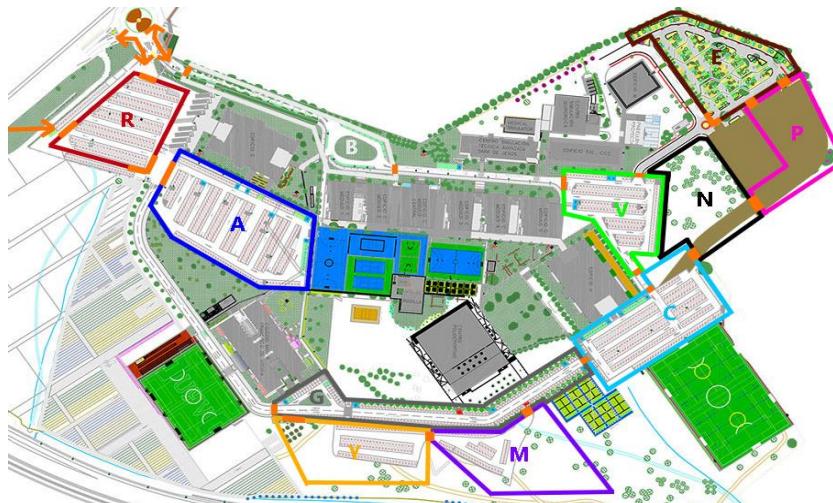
Zonas de Aparcamiento UFV – Elaboración Propia sobre el plano actual del Campus UFV [16] de Vanesa García
